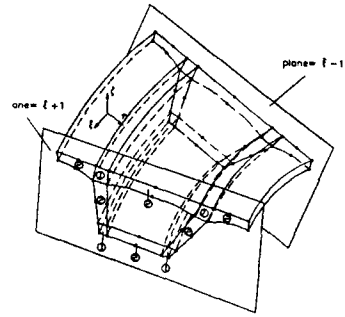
Typical box girder bridge macro element formed by an assembly of special purpose elements:
